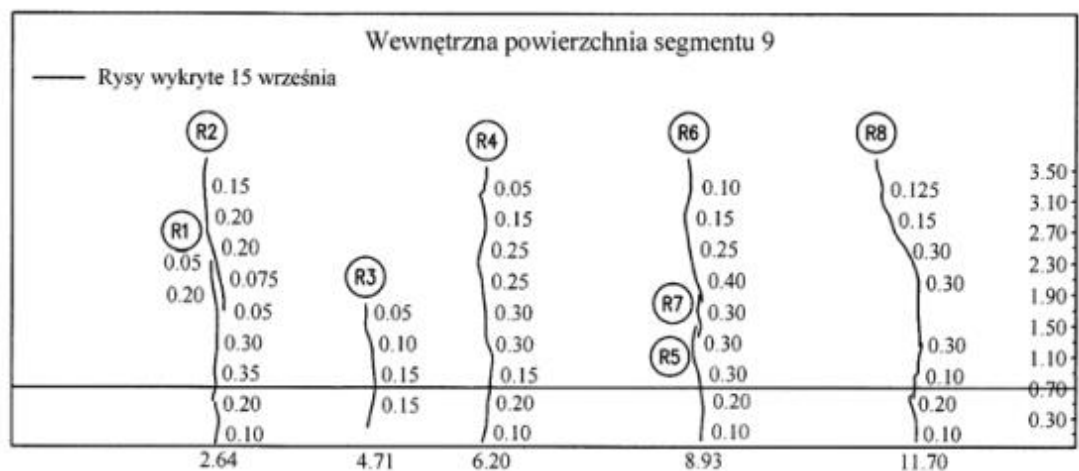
Seinän 8 halkeamien sijainnit ja mitatut halkeamaleveydet. [60]
